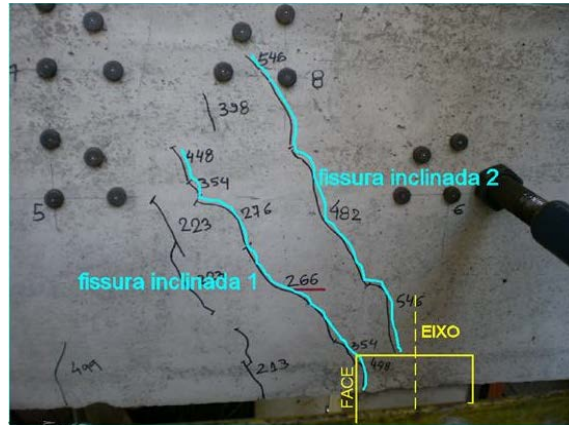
Detalhes do encontro da fissura na região da estaca - B120P375R4
